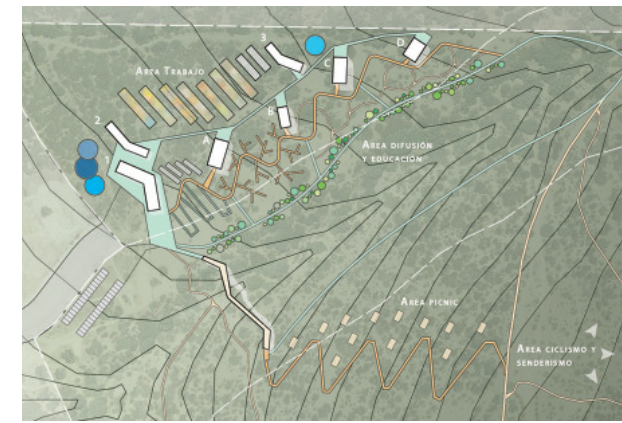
CROQUIS Y PLANIMETRÍAS DE LA ENTREGA DE PASE (17.07.12)
